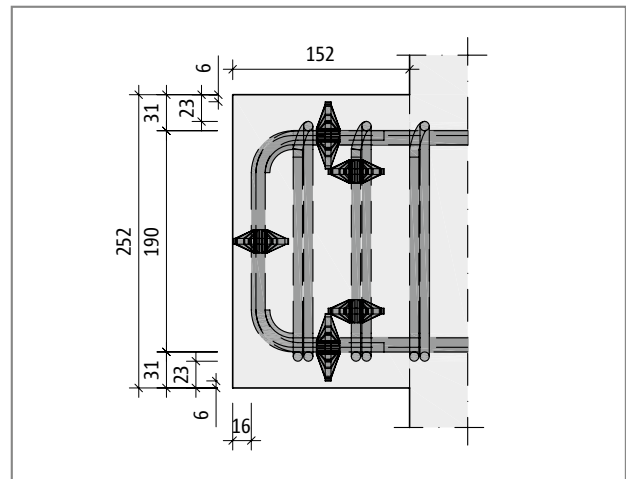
Schöck Tronsole® Typ Z: Grundriss einer Betonkonsole mit eingebautem Tragelement
